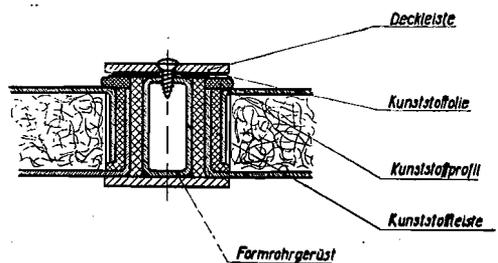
Wandplatte aus Stahlblech, Montage mit Spannleisten und Formrohrgerüst
